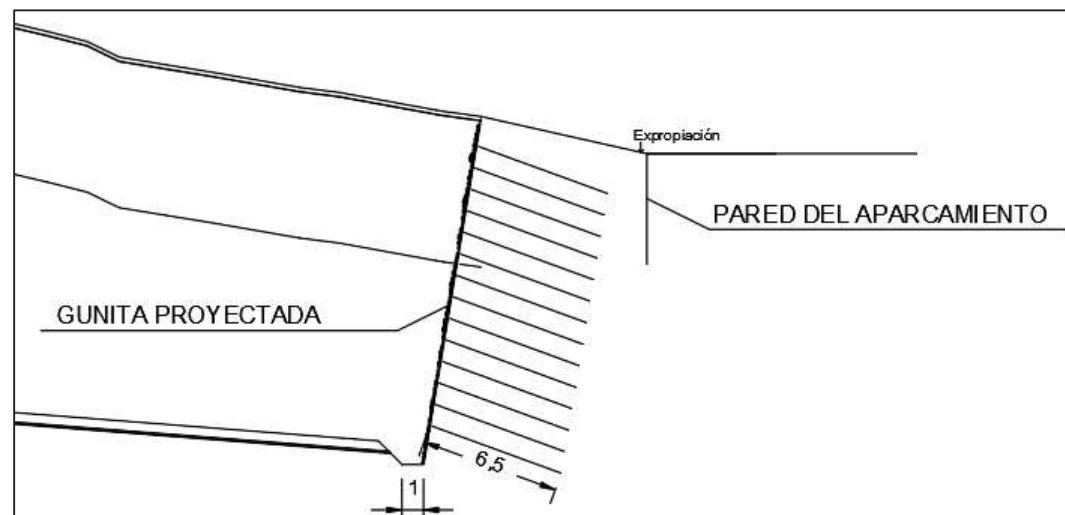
Tratamiento previsto en el Proyecto de Construcción
